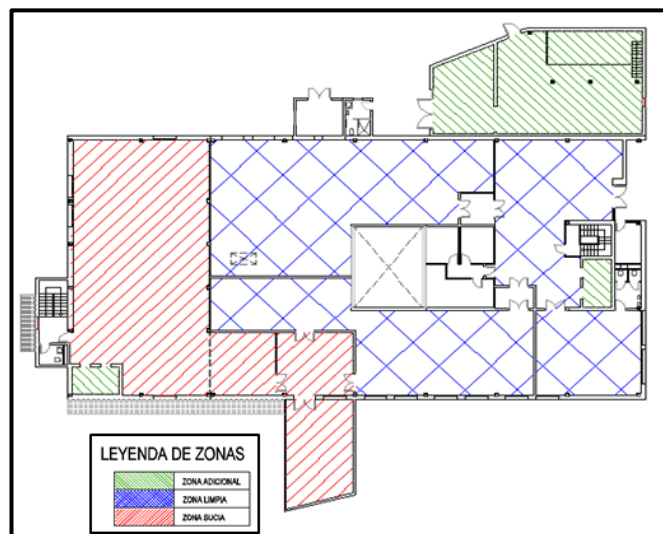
Vista en planta nivel +5,40 con distribución de zonas
